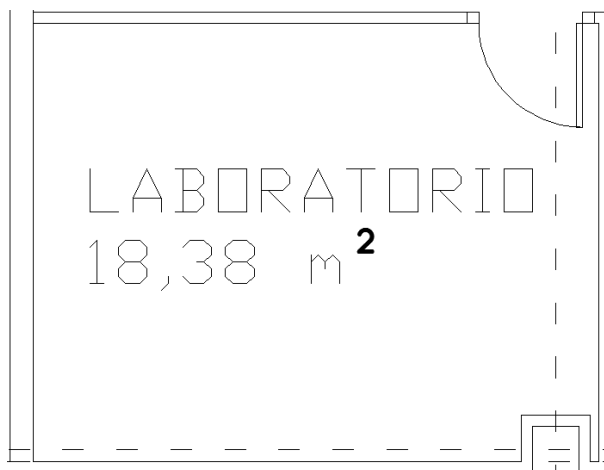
Vista del laboratorio. Fuente: Proyectista
